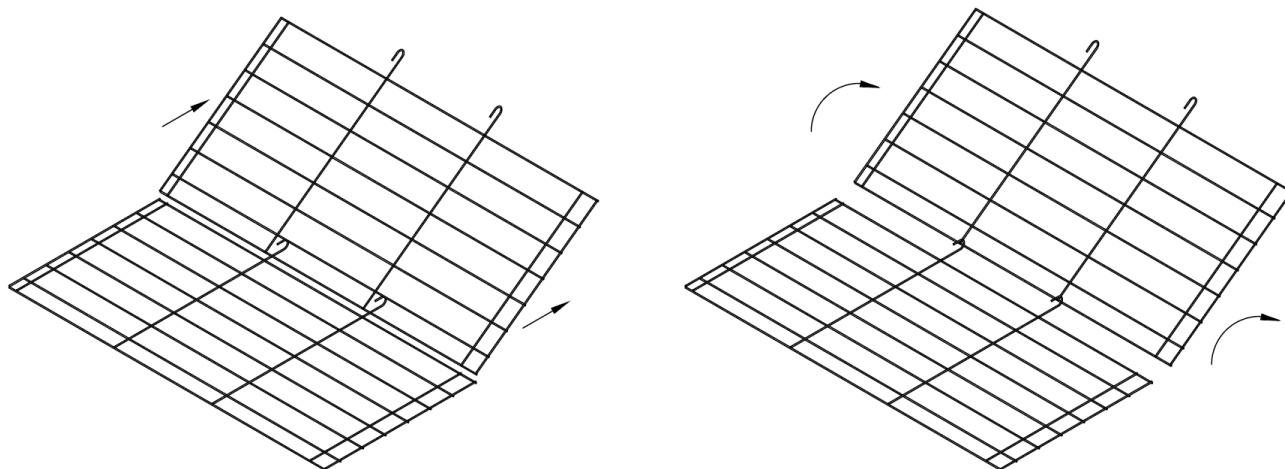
Umieszczenie siatki zabezpieczającej pod klapą (układ otwierający się poniżej górnej krawędzi podstawy pasma)
